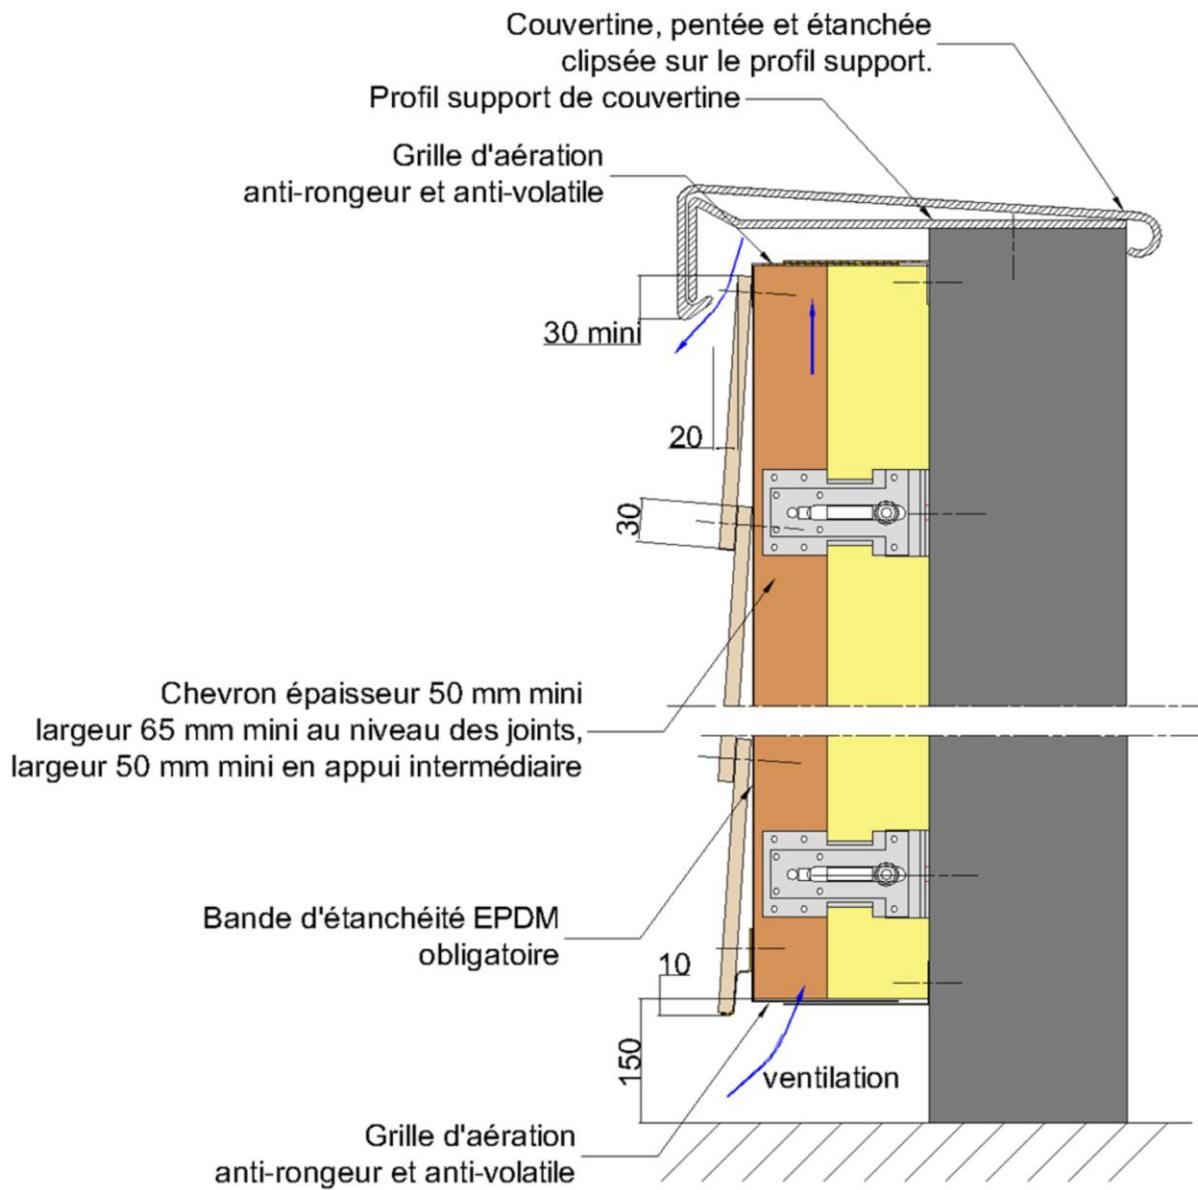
Rive haute et rive basse avec acrotère – Pose horizontale des lames CEDRAL LAP avec isolant
